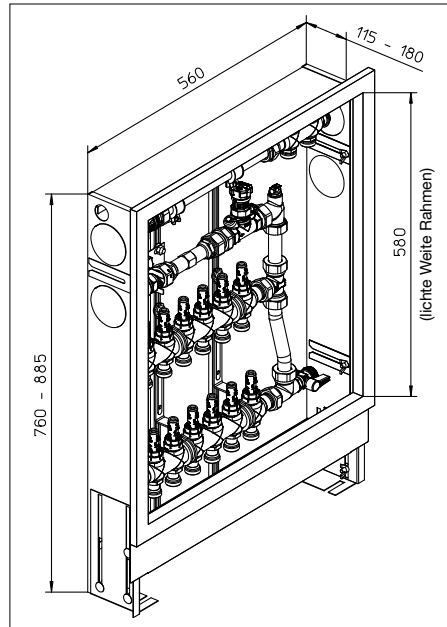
Abmessungen Einbauschrank Rücklaufsammler (gilt für alle Ausführungen Art.-Nr. 1027053/54/55/56)
